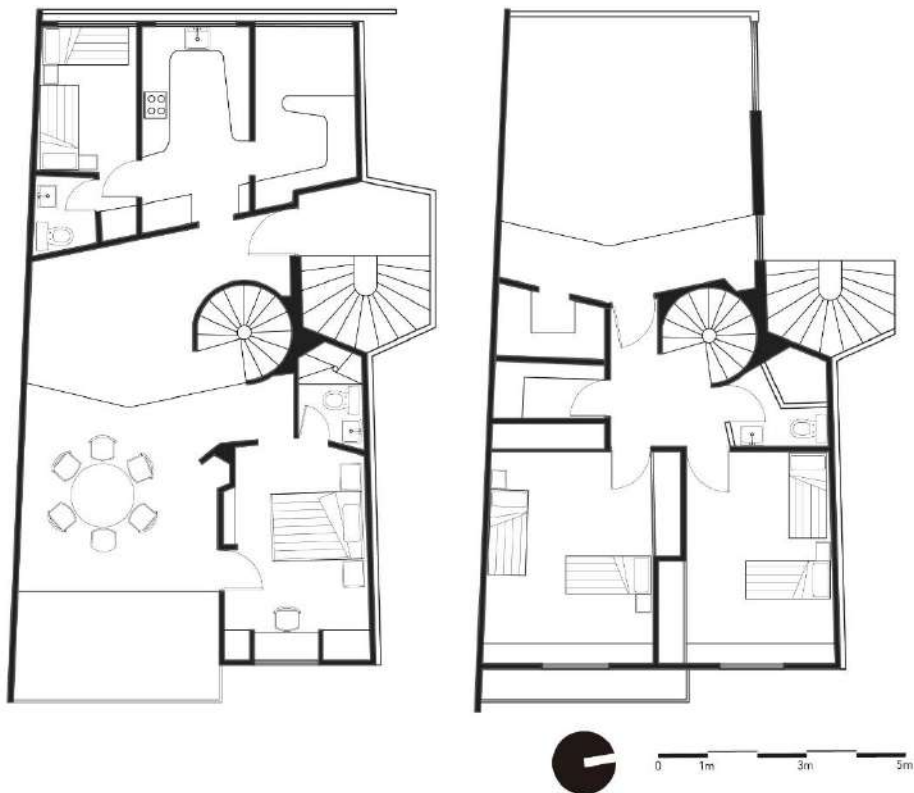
Planimetría Conjunto Residencial El Polo, primera y segunda planta. Tomado de: Camacho, D. (2015).
